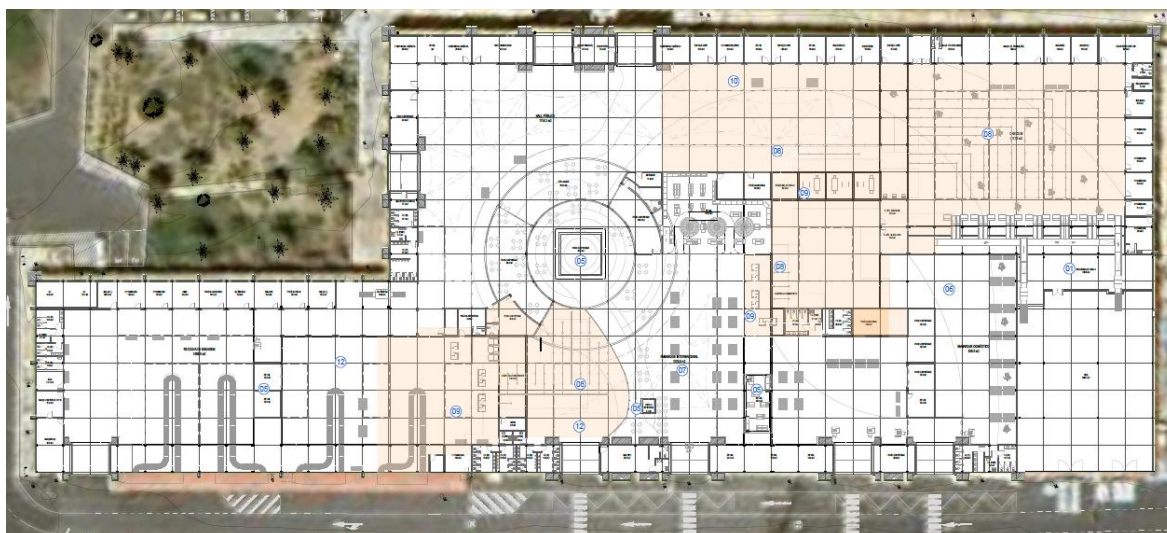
| Planta Sumária de Intervenções no Terminal BVC: Refit apenas
